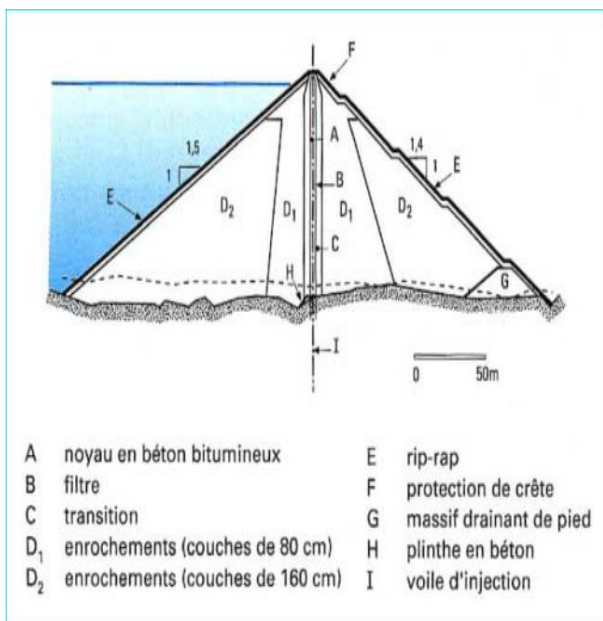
Barrage à noyau bitumineux de Storglomvatn (Norvège)
